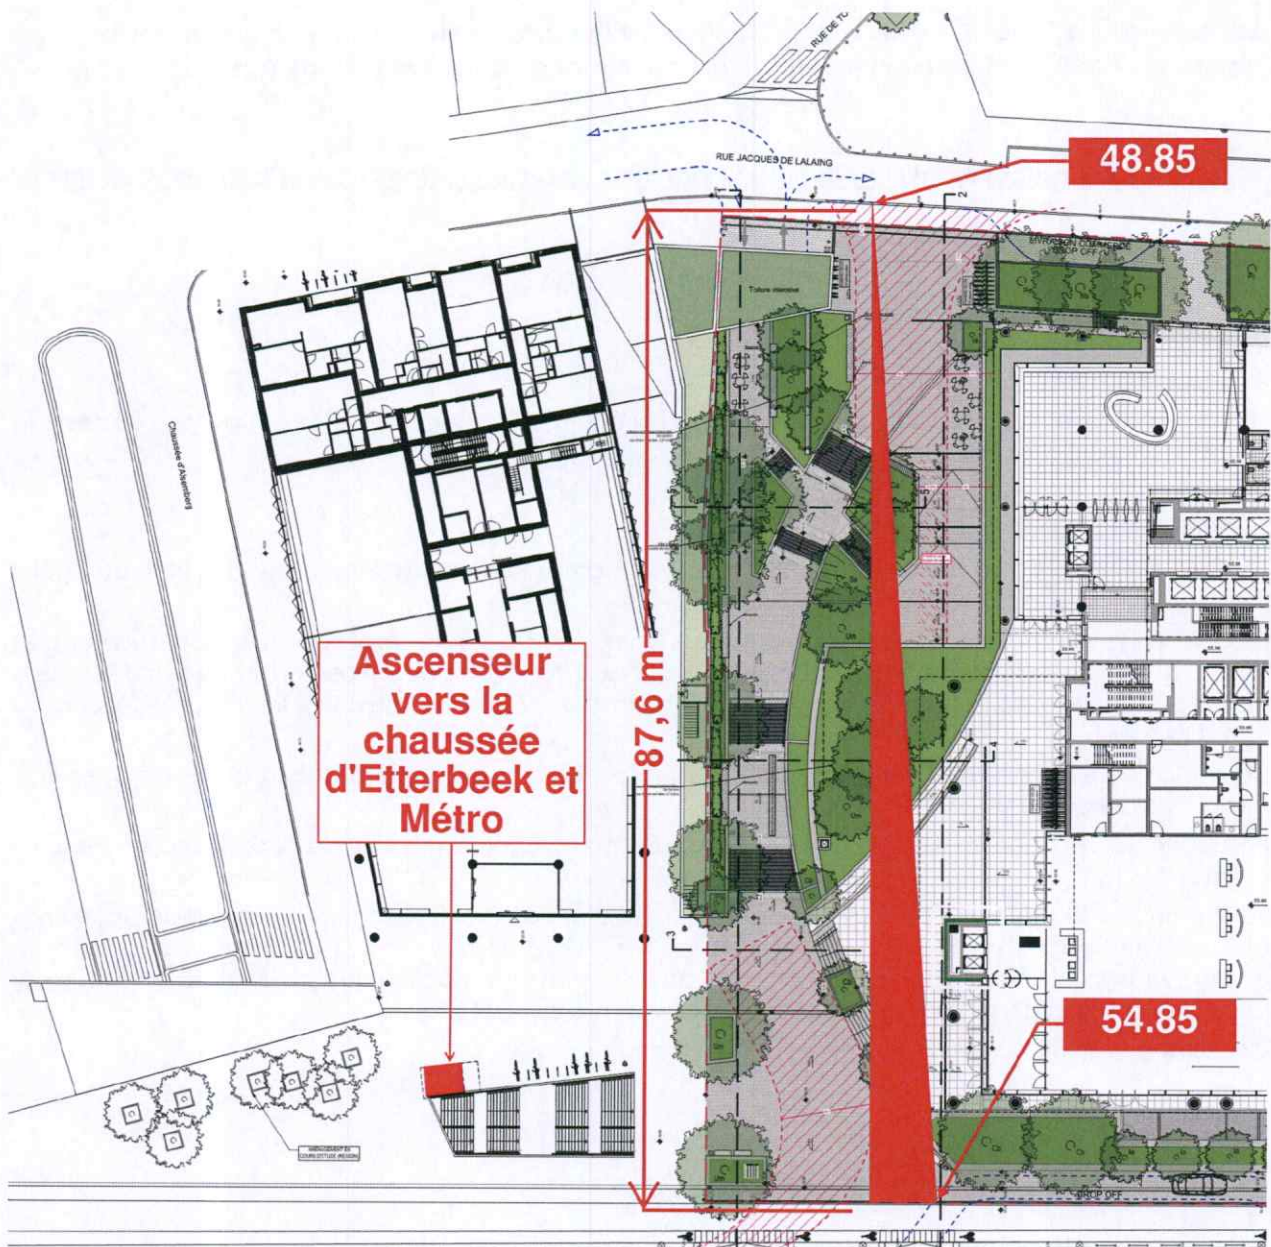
Accessibilité PMR entre les rues de la Loi et Jacques de Lalaing
